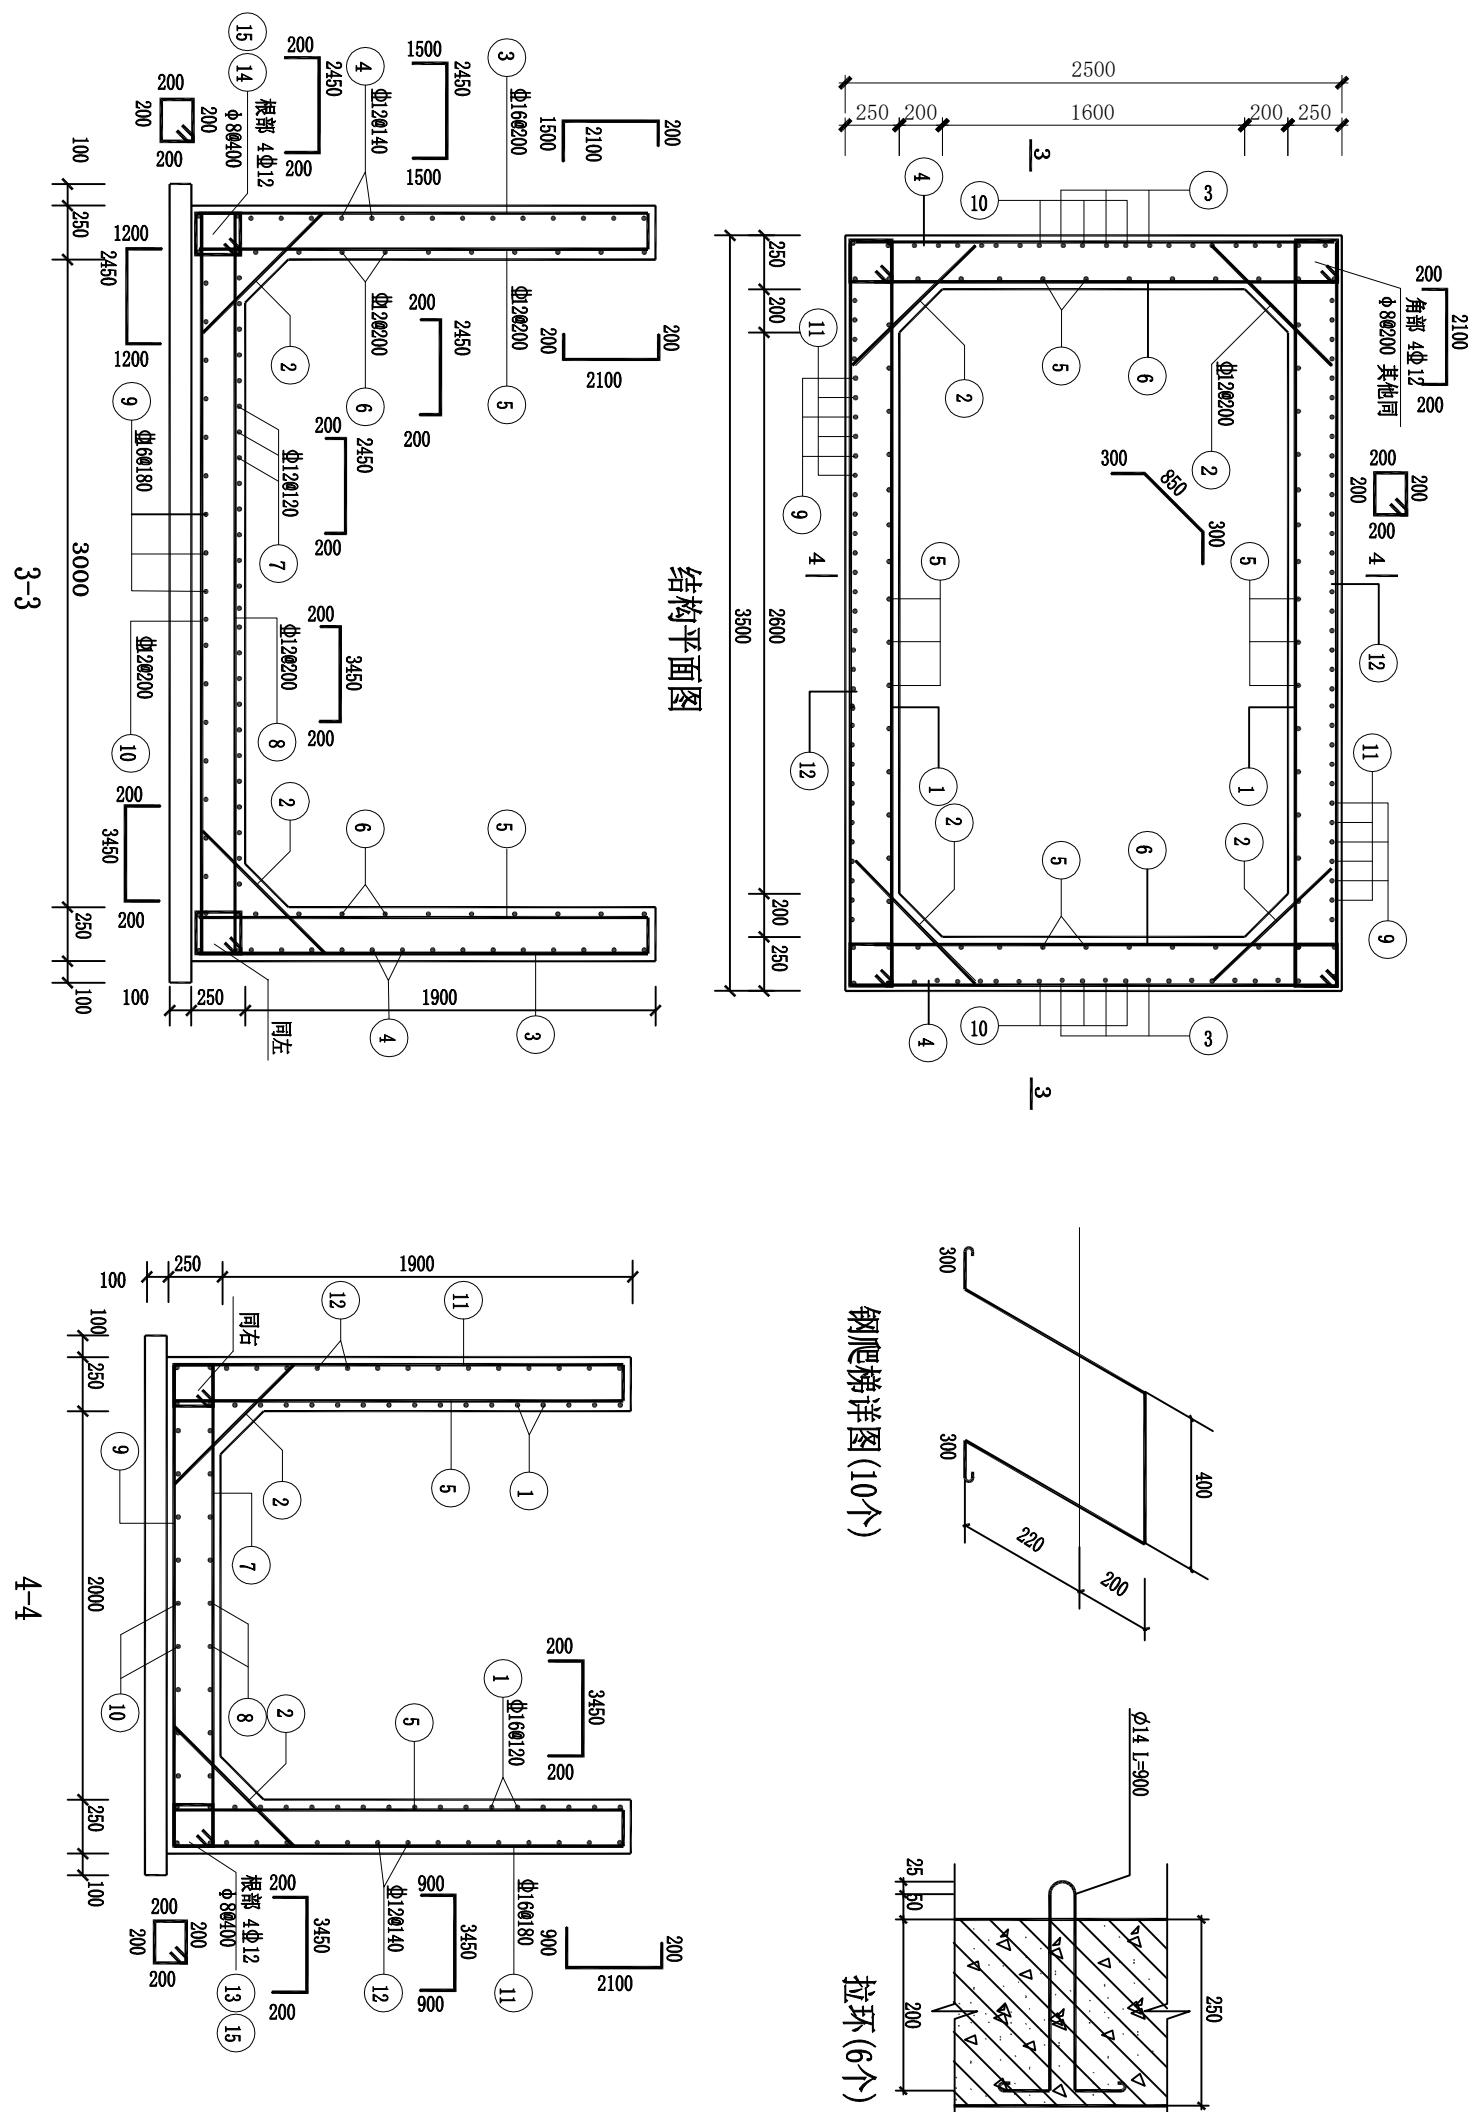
[3.0×2.0×1.9m钢筋混凝土直线电缆井 (B-1-13) (二)]
